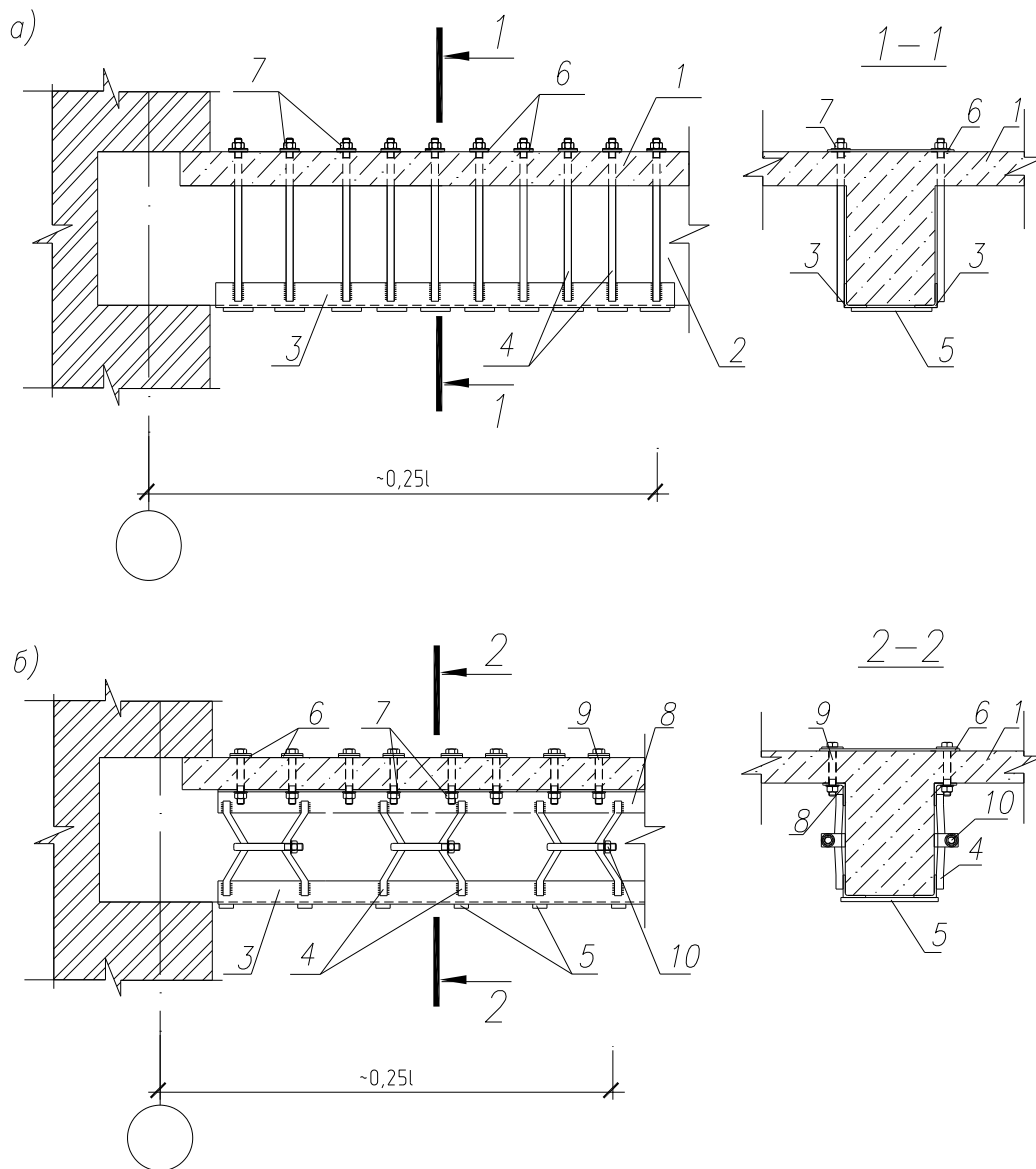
Схема усиления наклонных сечений железобетонных балок:
